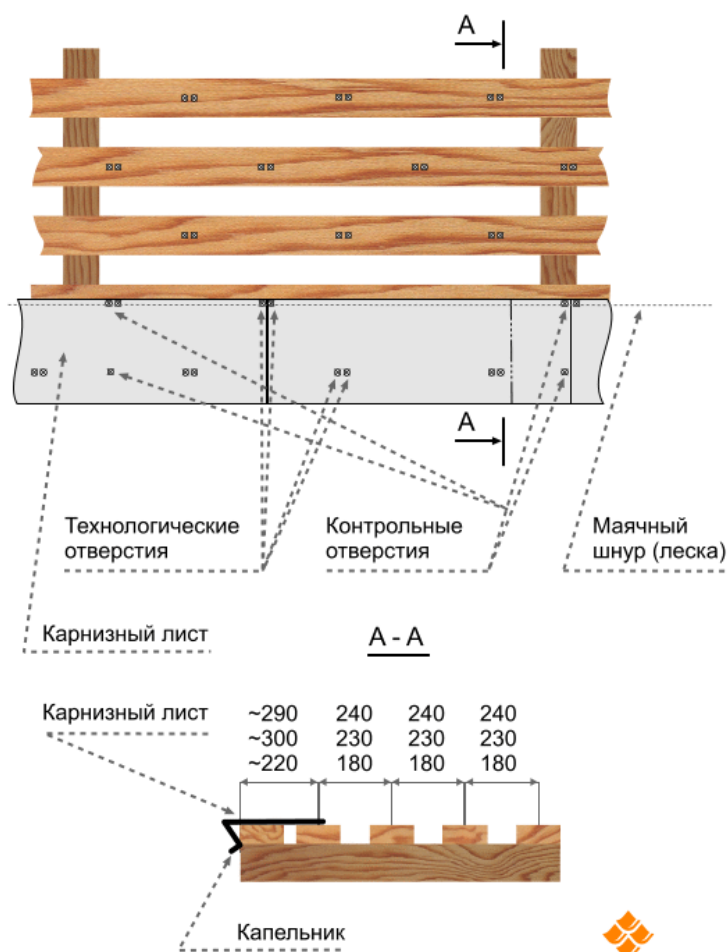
Схема расположения обрешётки и установки карнизных листов
